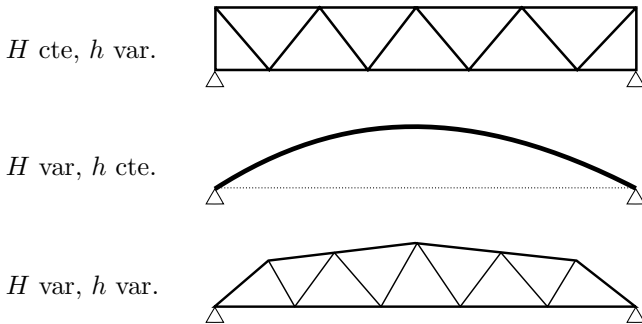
Tipos de estructura para flexión: viga, arco o cercha.
